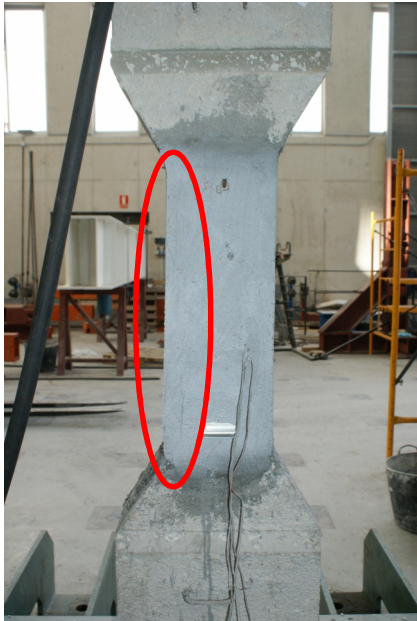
Pilar PR4C_R3+PU tras el ensayo a compresión. Fisuración cara C1.
